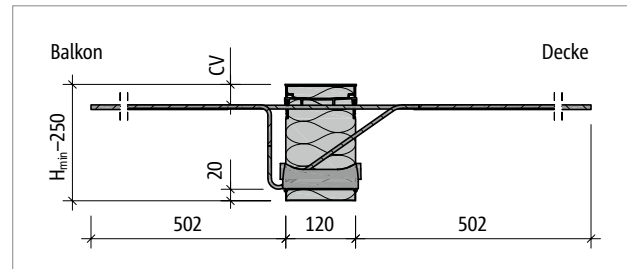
Schöck Isokorb® XT Typ K-M5, K-M6 bei R0: Produktschnitt
